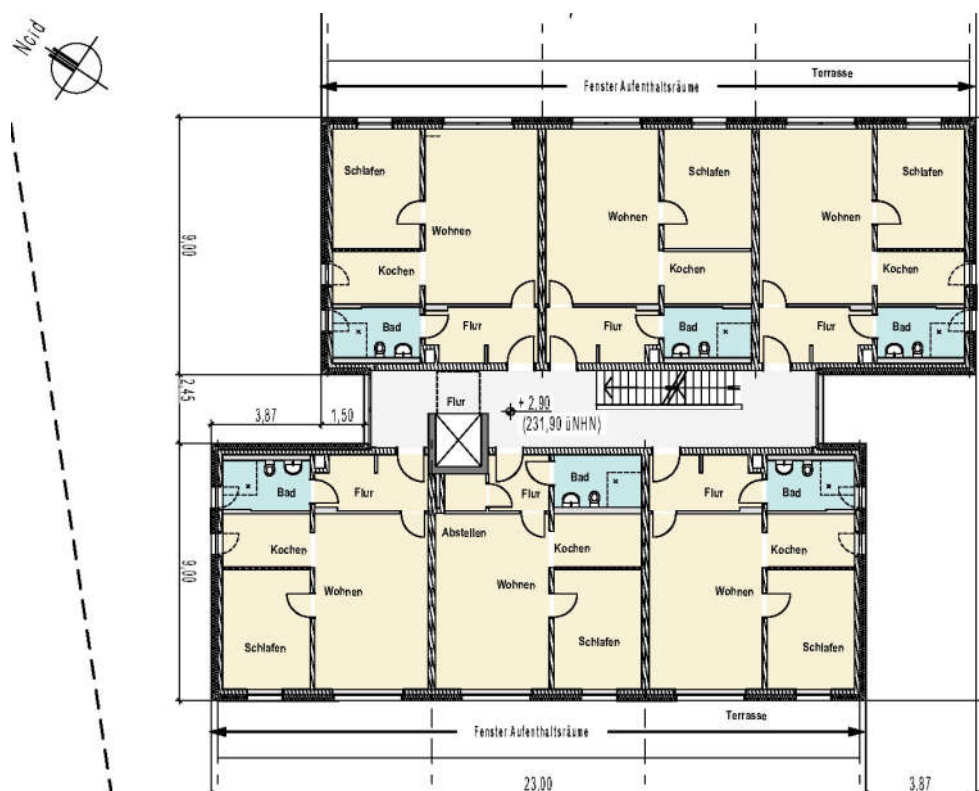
Grundriss 1. Obergeschoss / Betreutes Wohnen
